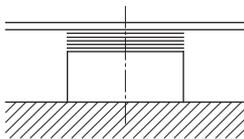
Cales d'épaisseur sur la surface de fondation
